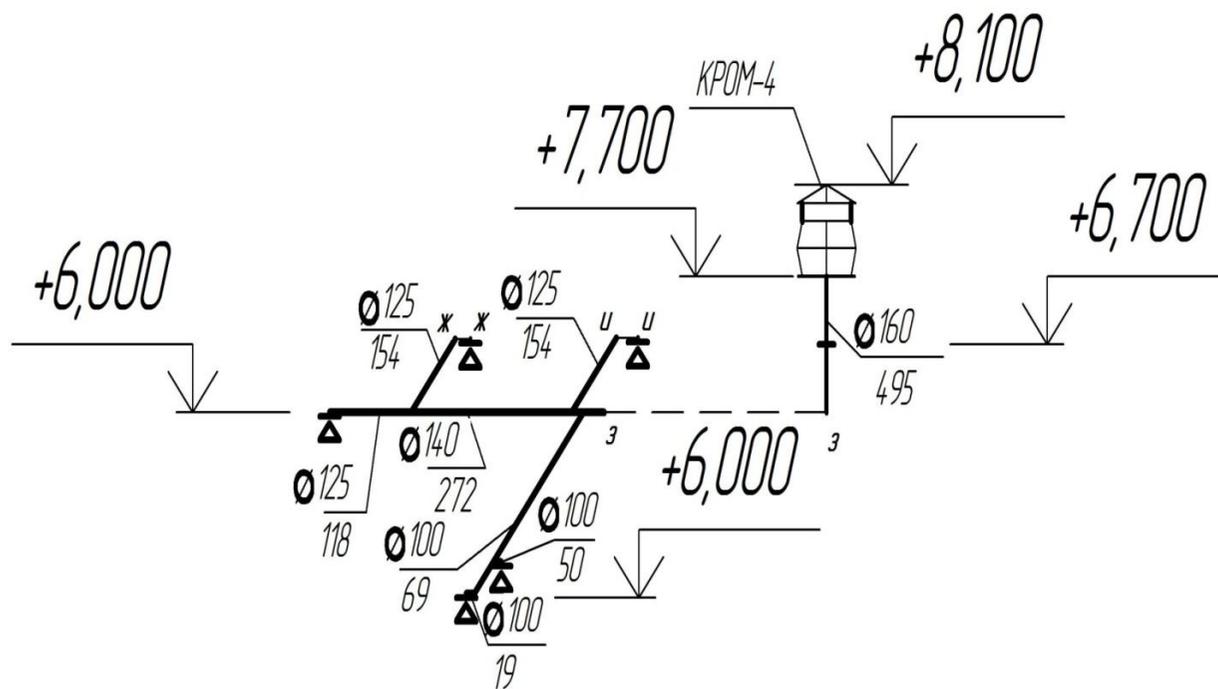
Схема вытяжной вентиляции ВЗ
